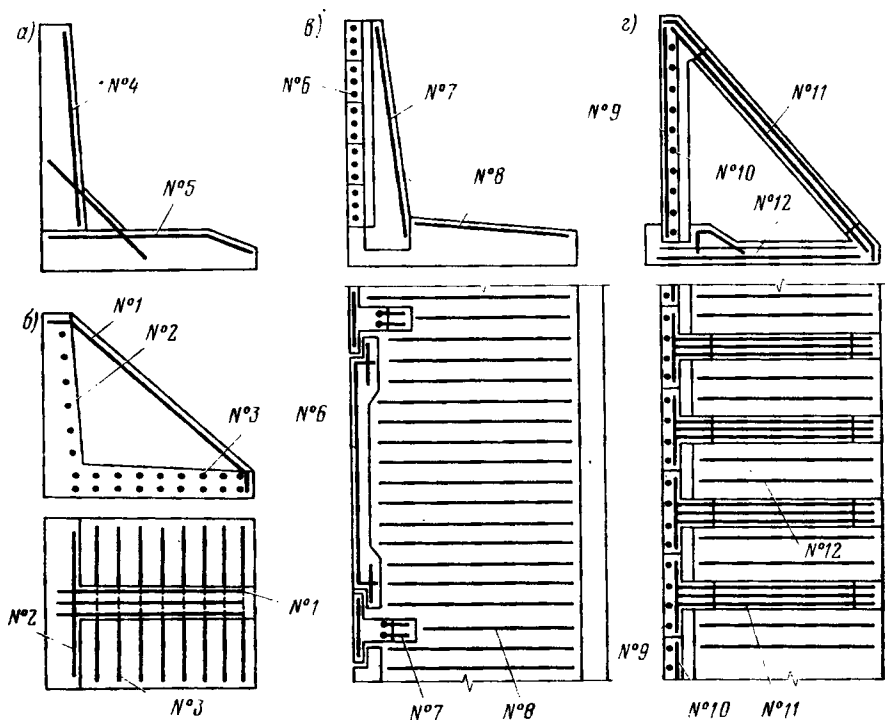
Схемы армирования железобетонных подпорных стен:
